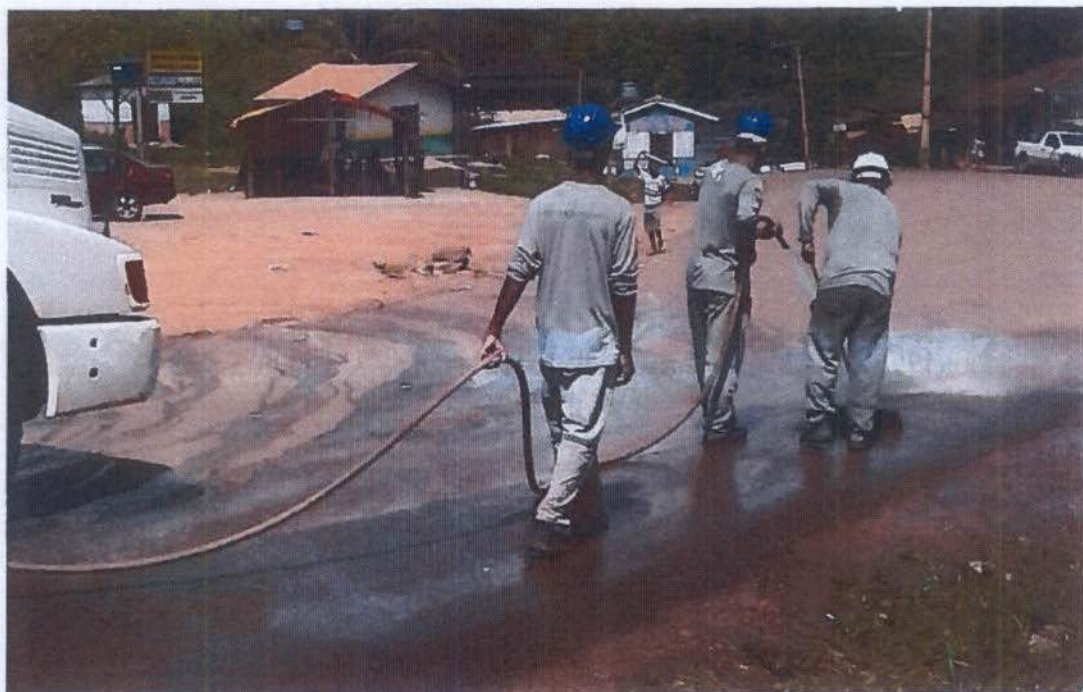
Limpeza da pavimentação para pintura da pista, (lado Belo Monte do Pontal).
